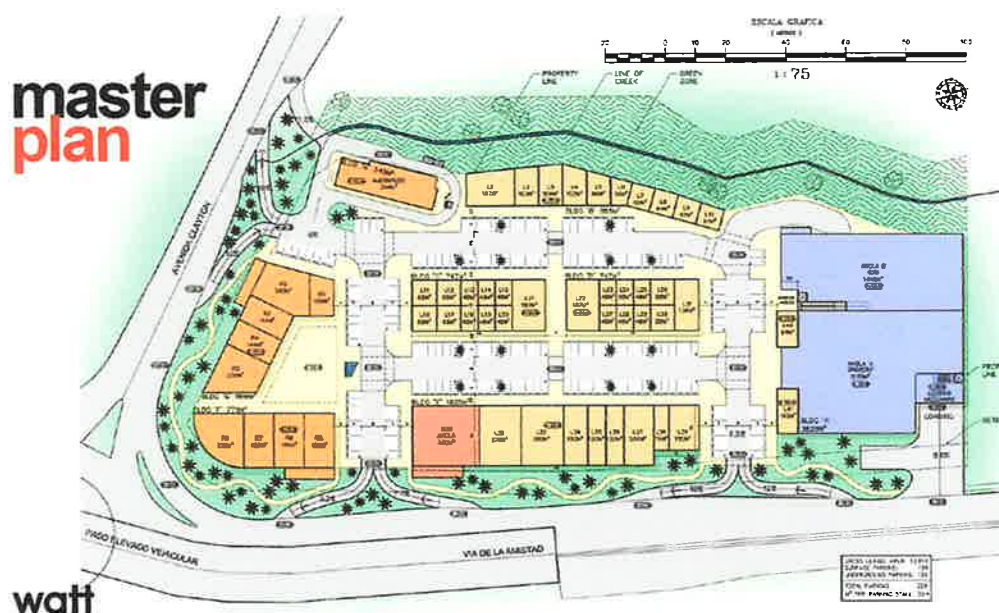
Plan Maestro Clayton Station. Fuente: Equipo diseñador
